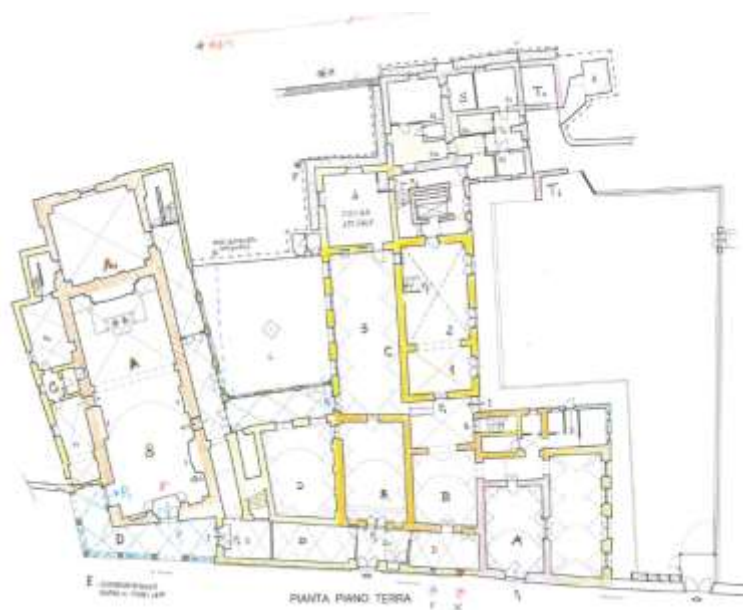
Pianta del piano terra del complesso di San Lorenzo.
